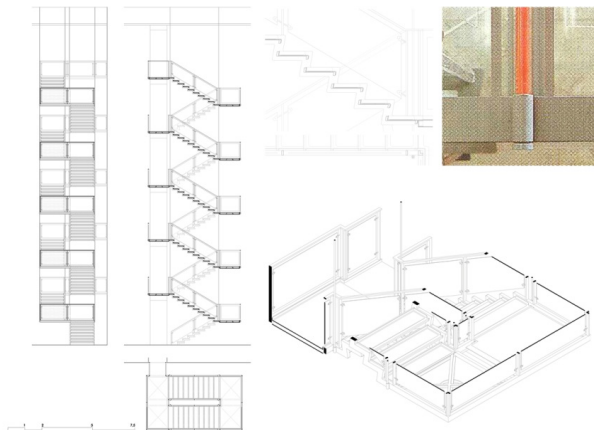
Planta, alzado y sección vertical de la escalera del Hotel SAS. Fotografía de detalles. 2011. Foto-autor.
